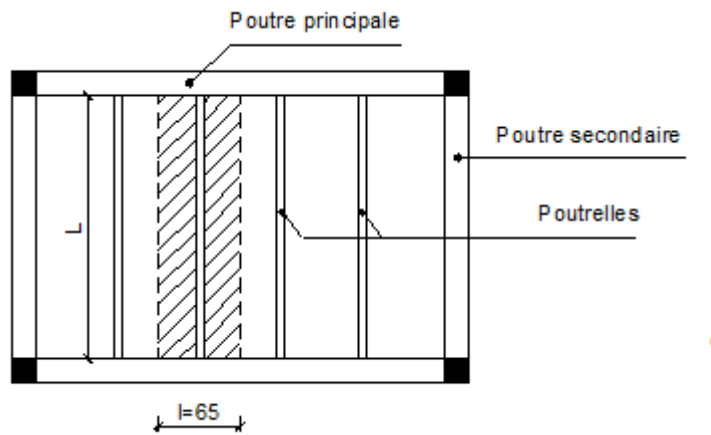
Vue en plan de plancher a corps creux [22] .
